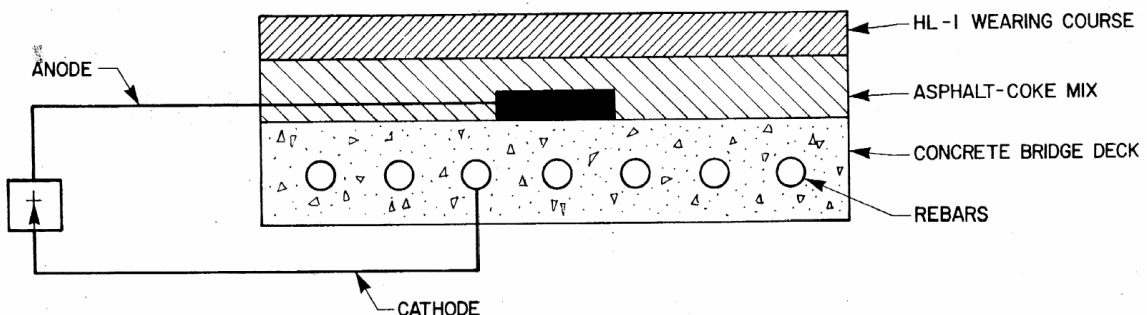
Prinzipskizze der ersten KKS-Installation Sly-Park Brücke, 1973.
